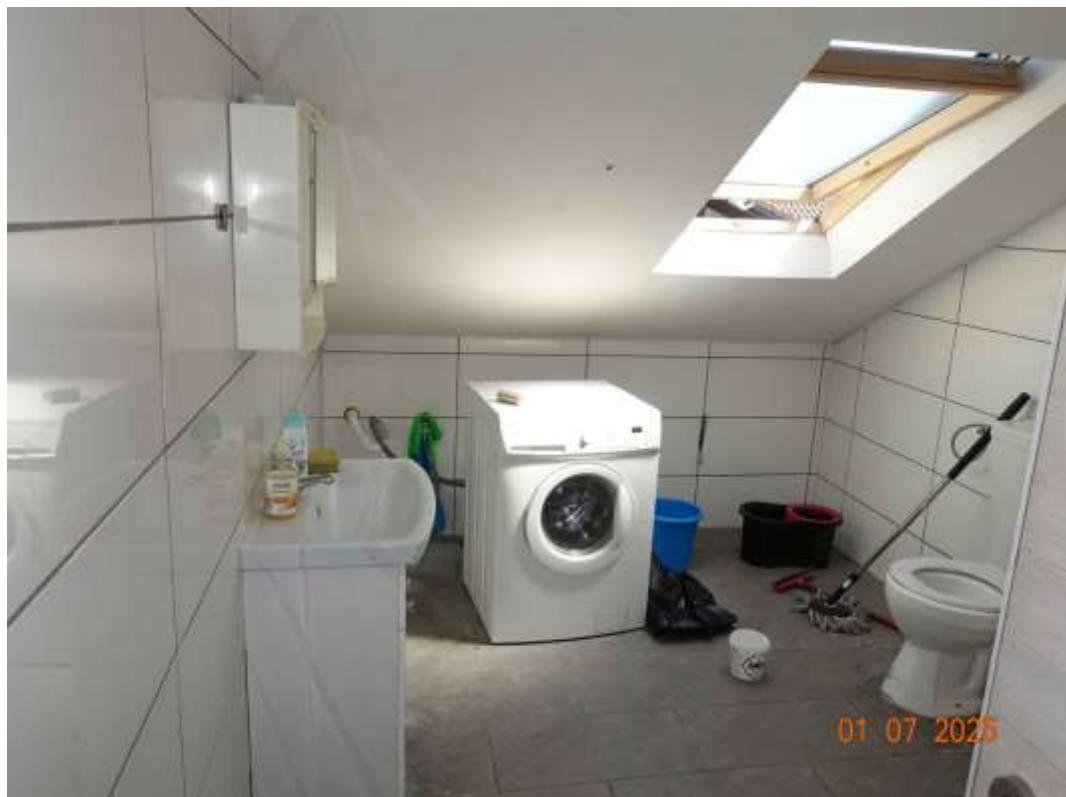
Bildausschnitt im Bad im Dachgeschoß
